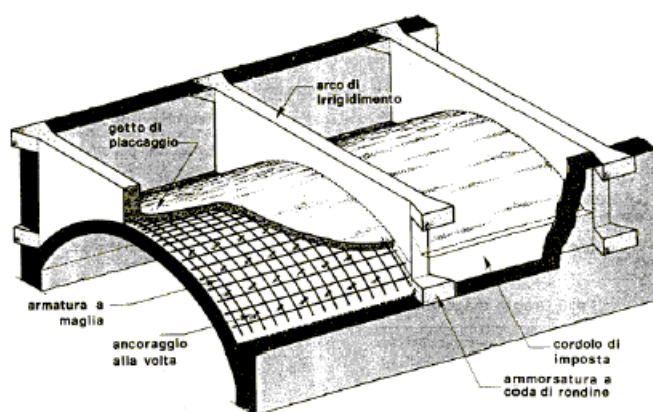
Consolidamento di volta a botte con cappa in calcestruzzo armato posta all'estradosso, poi irrigidita ed ancorata con archi in cemento armato.
